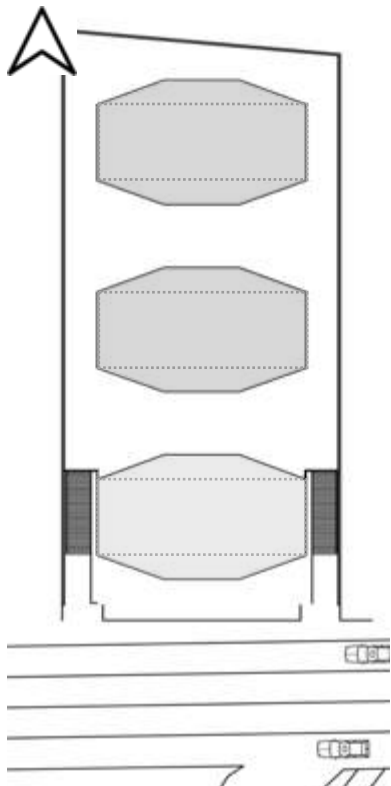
Zonificación planta baja de volúmenes en el sitio, etapa c.
